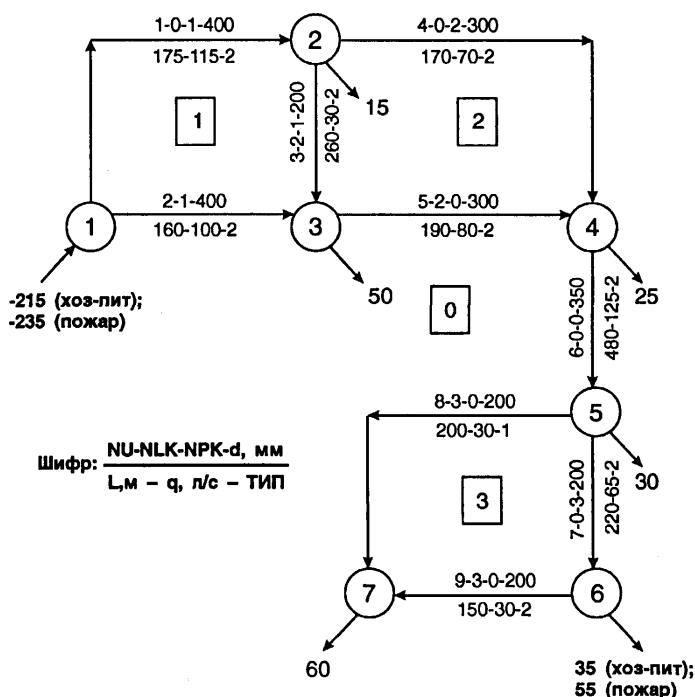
Расчетная схема водопроводной сети для ЭВМ
